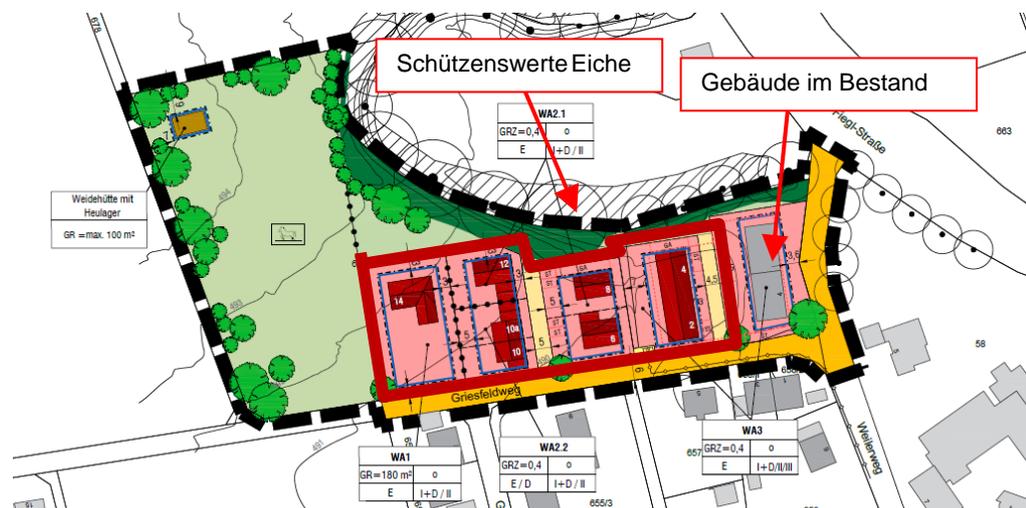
Ermittlung der Eingriffsfläche: rote Umrandung stellt die Eingriffsfläche dar; im östlichen Bereich besteht bereits ein Wohngebäude
